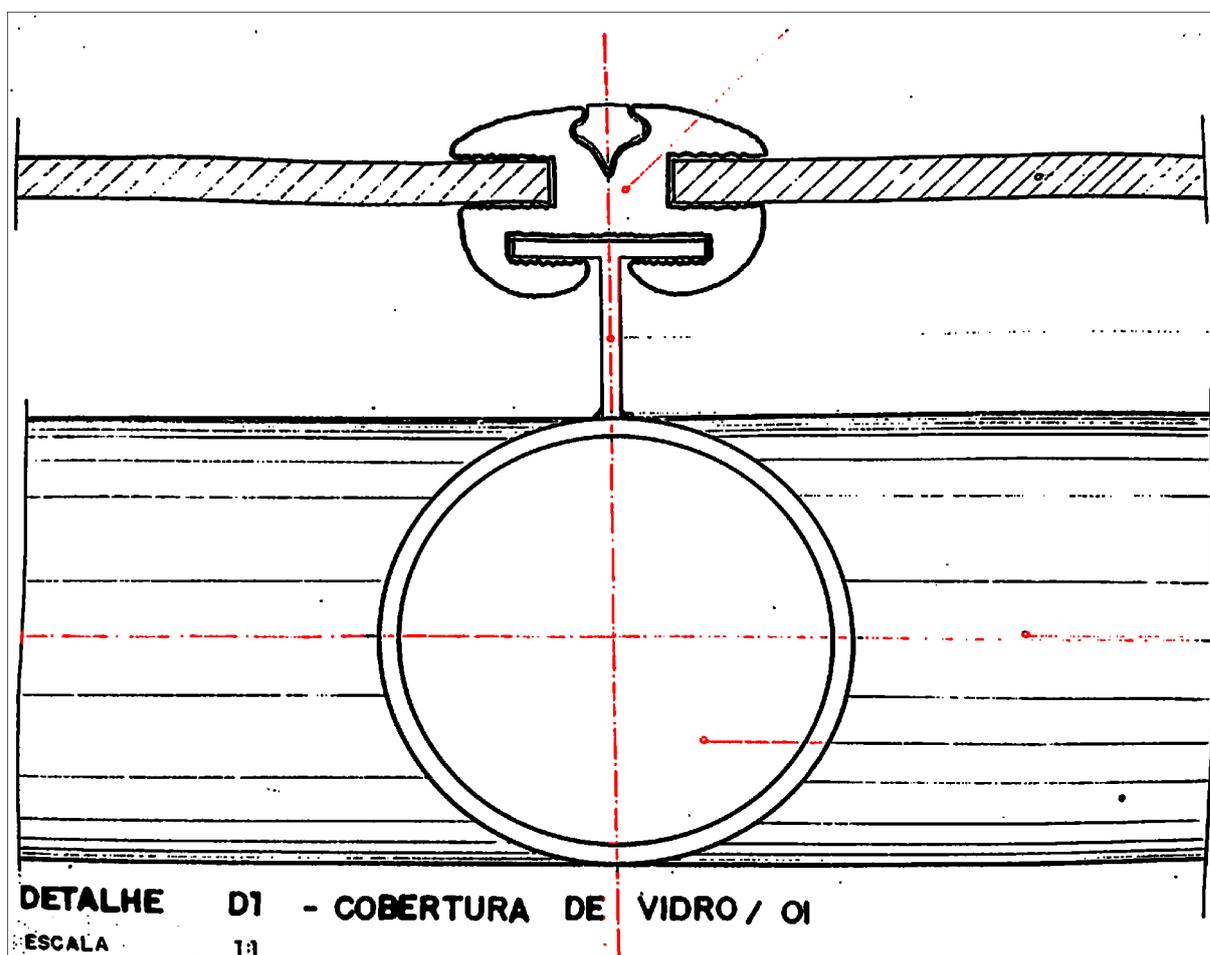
Detalhe do projeto original, encaixe cobertura de vidro na estrutura metálica.
